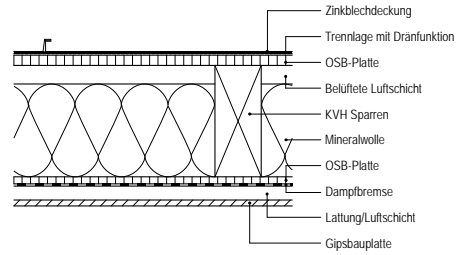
Belüftetes Dach mit nicht belüfteter Dachdeckung (Konstruktion 2)
